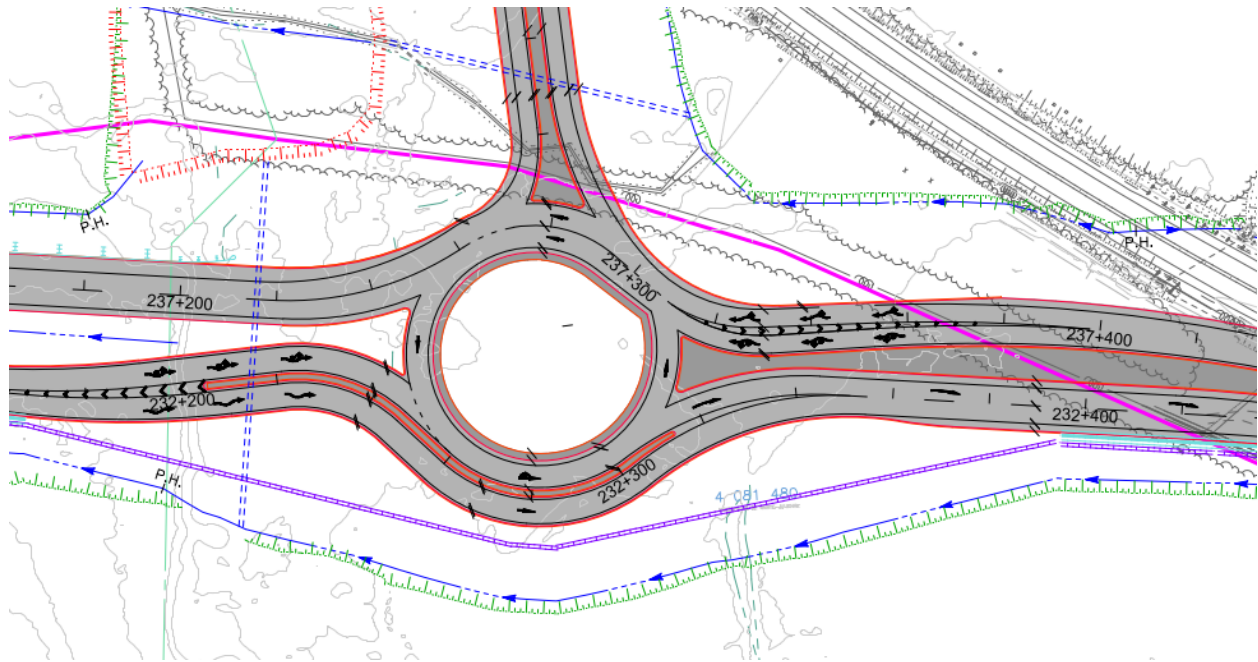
Turbo giratoire – Intersection nord route de contournement et R-125 existante
